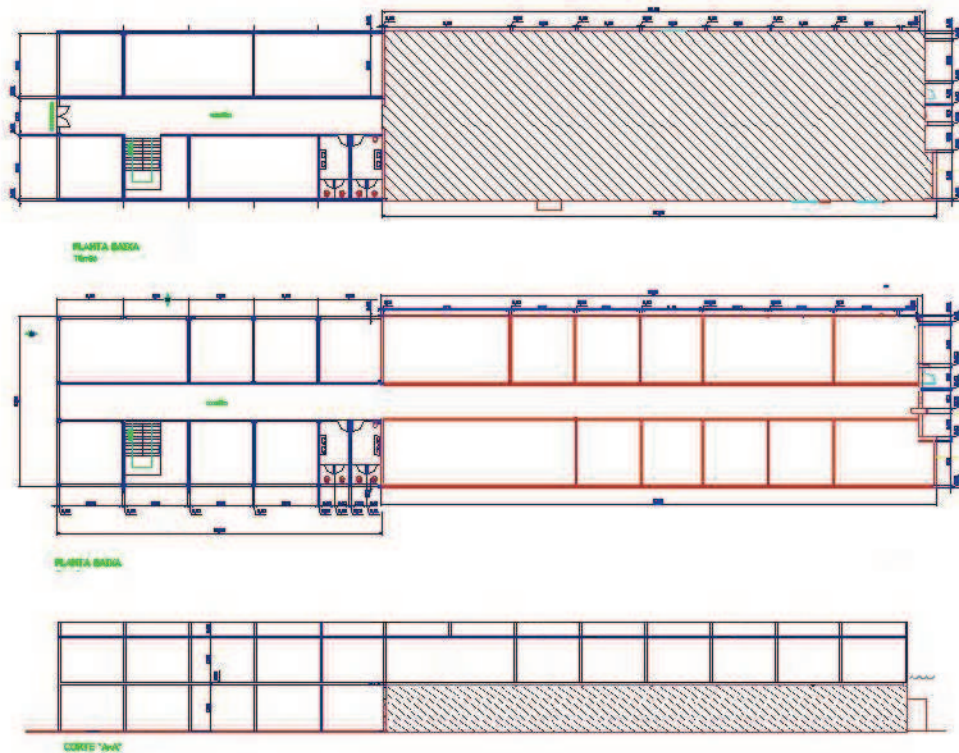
expansão do Laboratório EIPaso. Piso térreo (topo), piso superior (meio) e corte lateral (área existente em hachurado).
